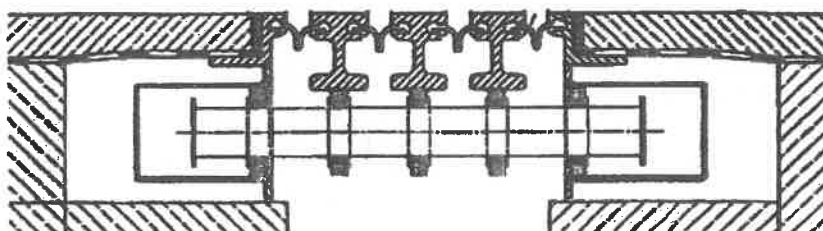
Sectiune transversala rost de dilatatie modular cu traversa, pentru suprafata pietonala. Figura prezinta dispunerea traversei pentru ghidaj.
